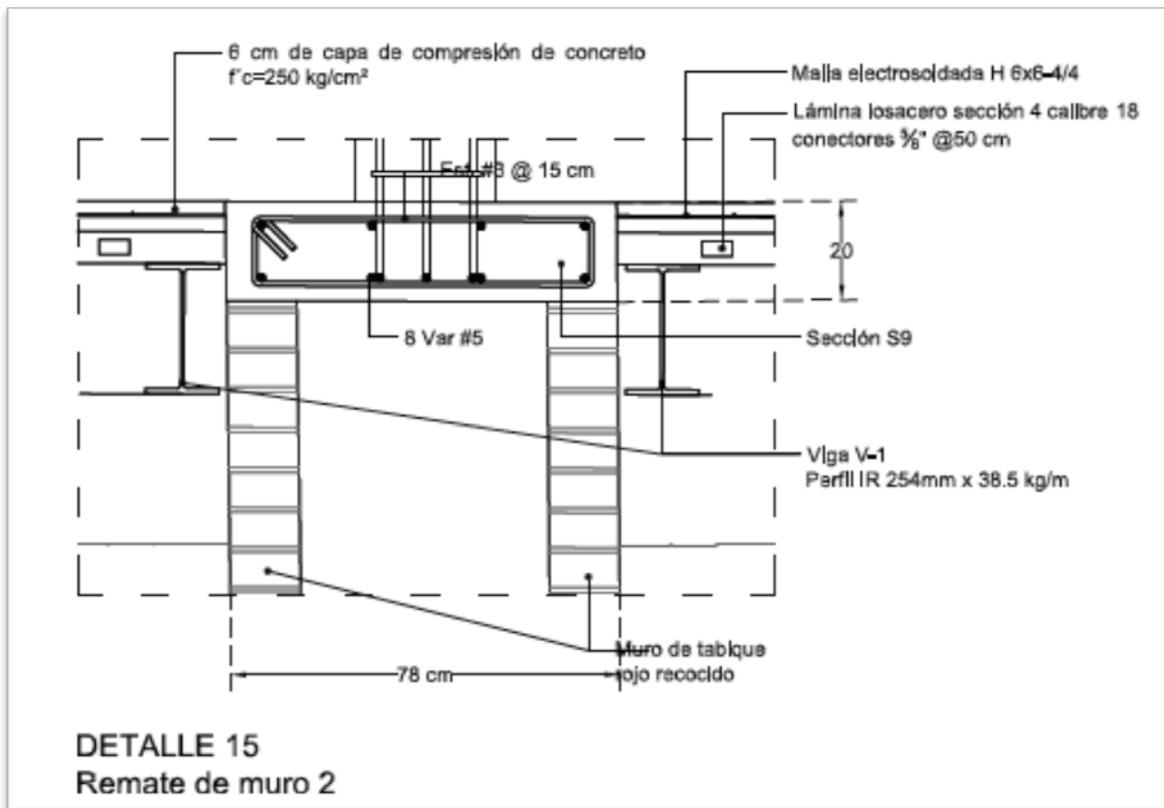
Detalle constructivo de muro doble de tabique. Detalle elaborado por Instituto de Ingeniería.
